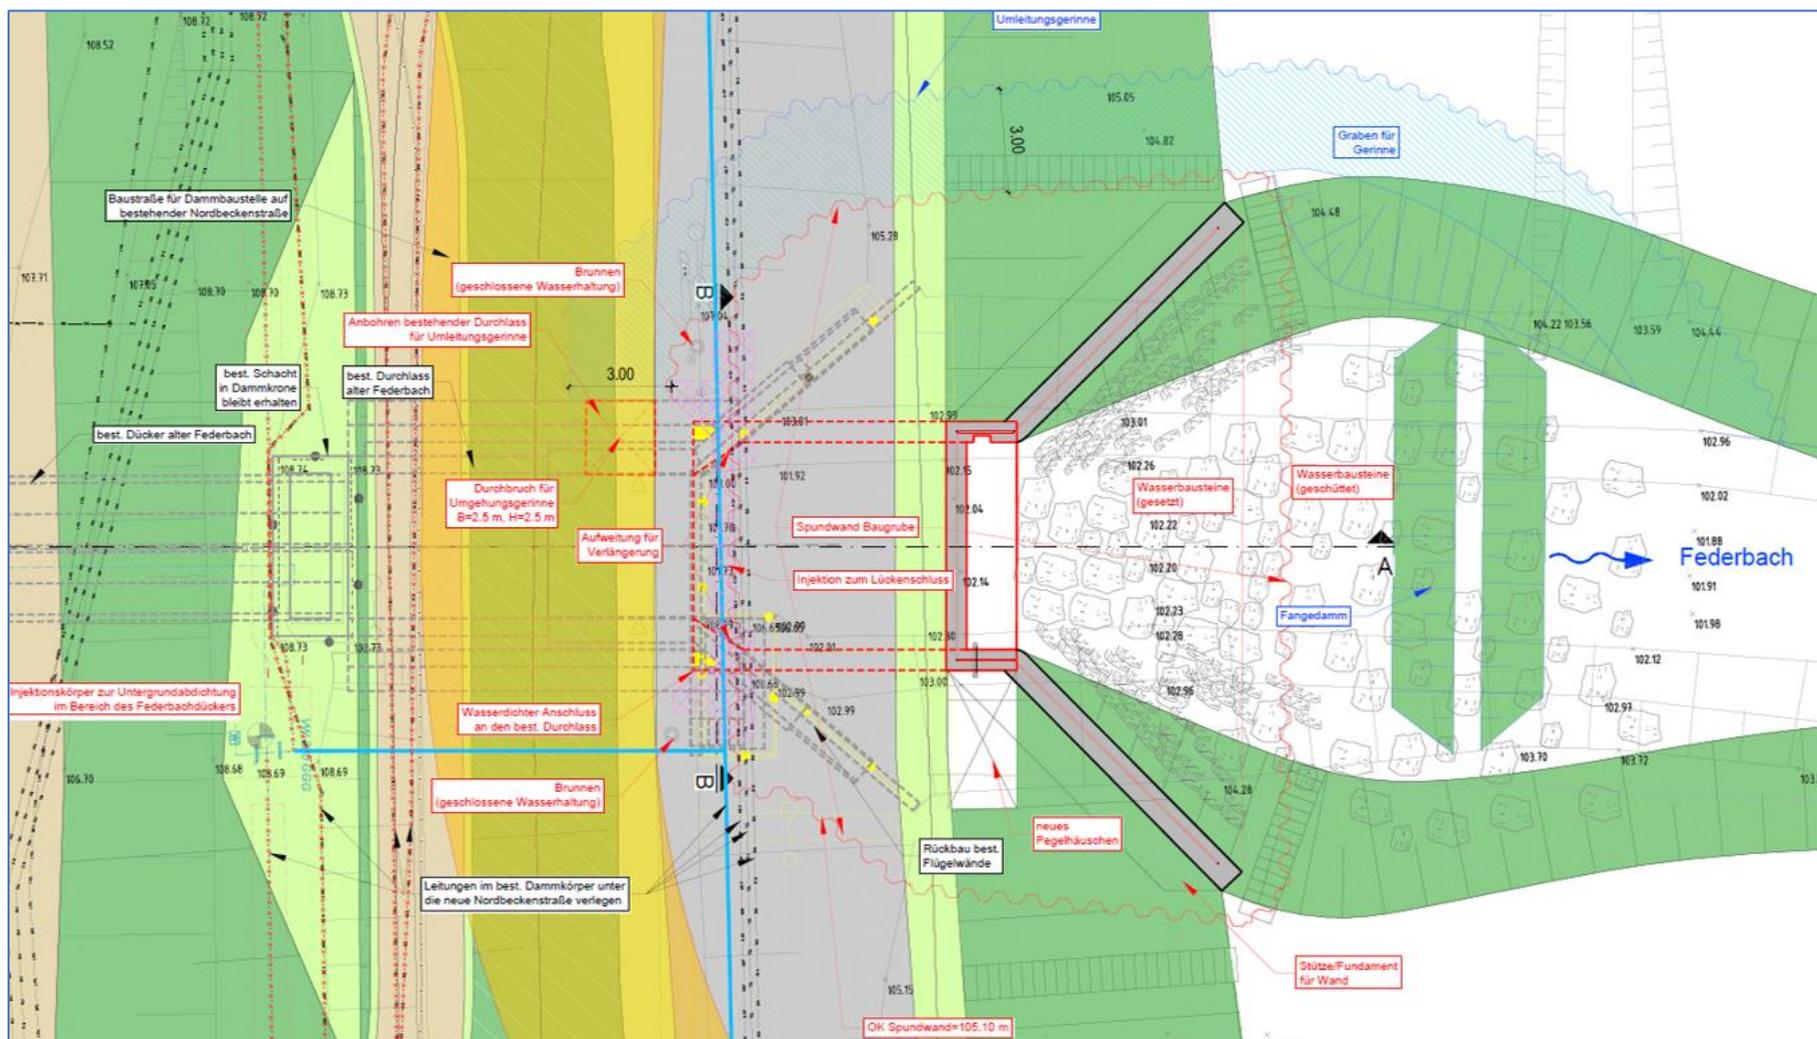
Planung Verlängerung Federbachdükers (Quelle: Anlage 2.1 zum Planfeststellungsantrag, Darstellung ist nicht genordet)
